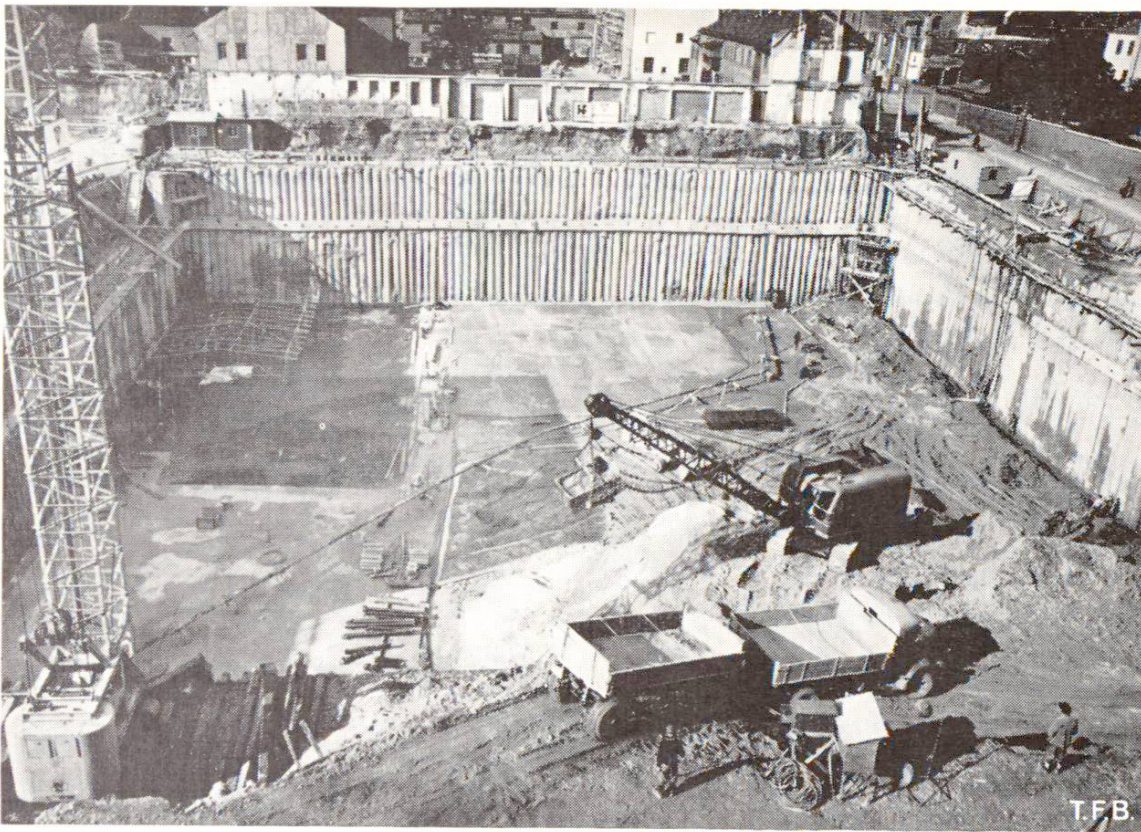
Blindage des parois d'une fouille par le système BENOTO en piles sécantes type 880/750. Fondation du bâtiment de la Radiodiffusion bavaroise, Munich.
